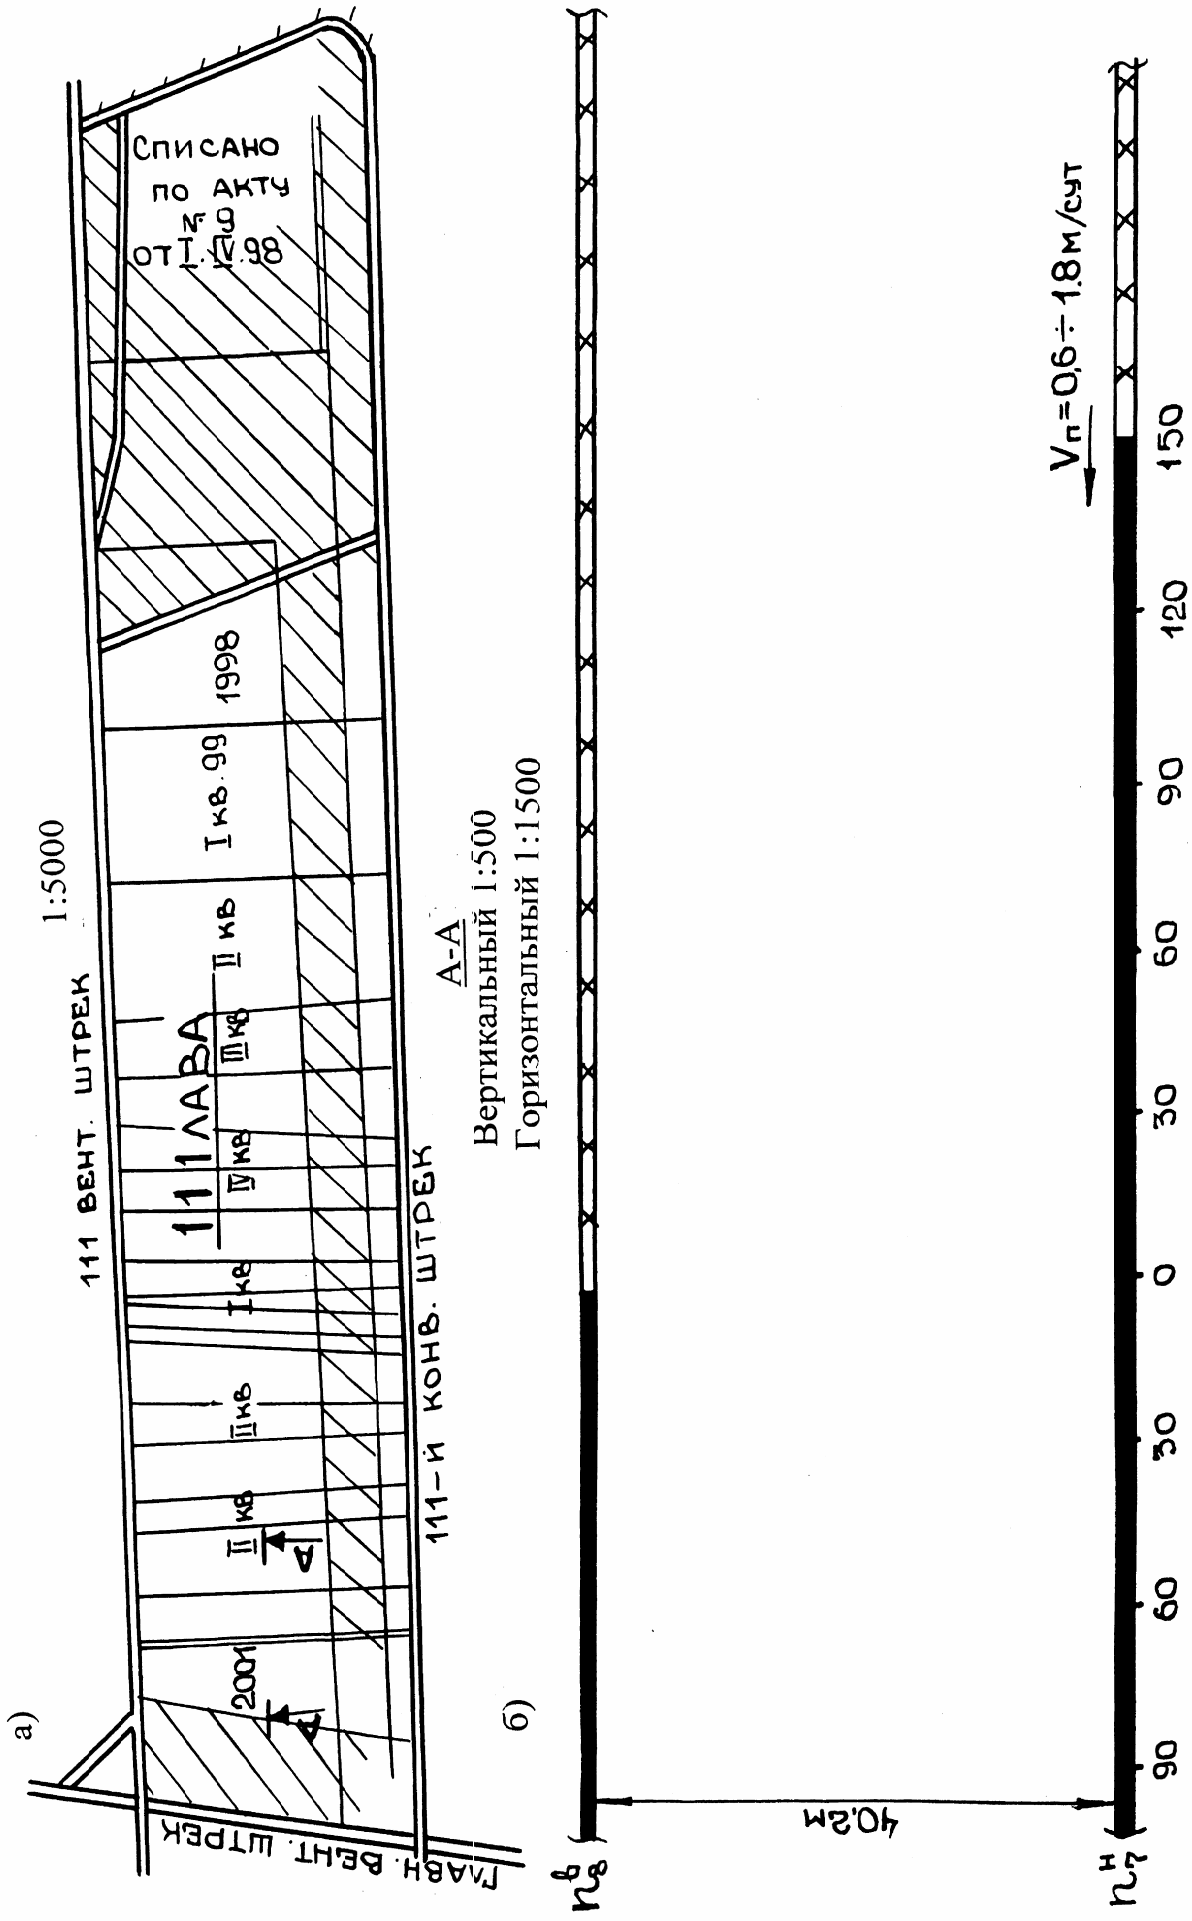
Выкопировка из плана горных работ (а) и продольный разрез выемочного столба 111 лавы (б)
